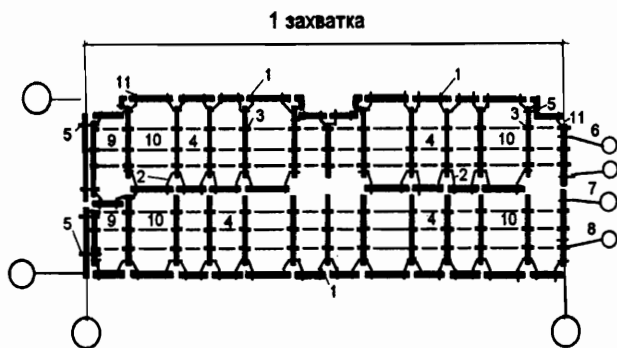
Схема расстановки монтажной оснастки для временного крепления стеновых панелей при возведении подземной части жилого дома: 1 – угловая струбцина для крепления цокольных панелей; 2 – угловая струбцина для крепления внутренних продольных стен; 3 – начальная штанга с осевым фиксатором; 4, 9, 10 – звеньевые штанги с осевым фиксатором; 5 – струбцина для спаренных панелей; 6, 7, 8 – струбцины с подкосом; 11 – угловая струбцина для крепления цокольных панелей в торце здания
